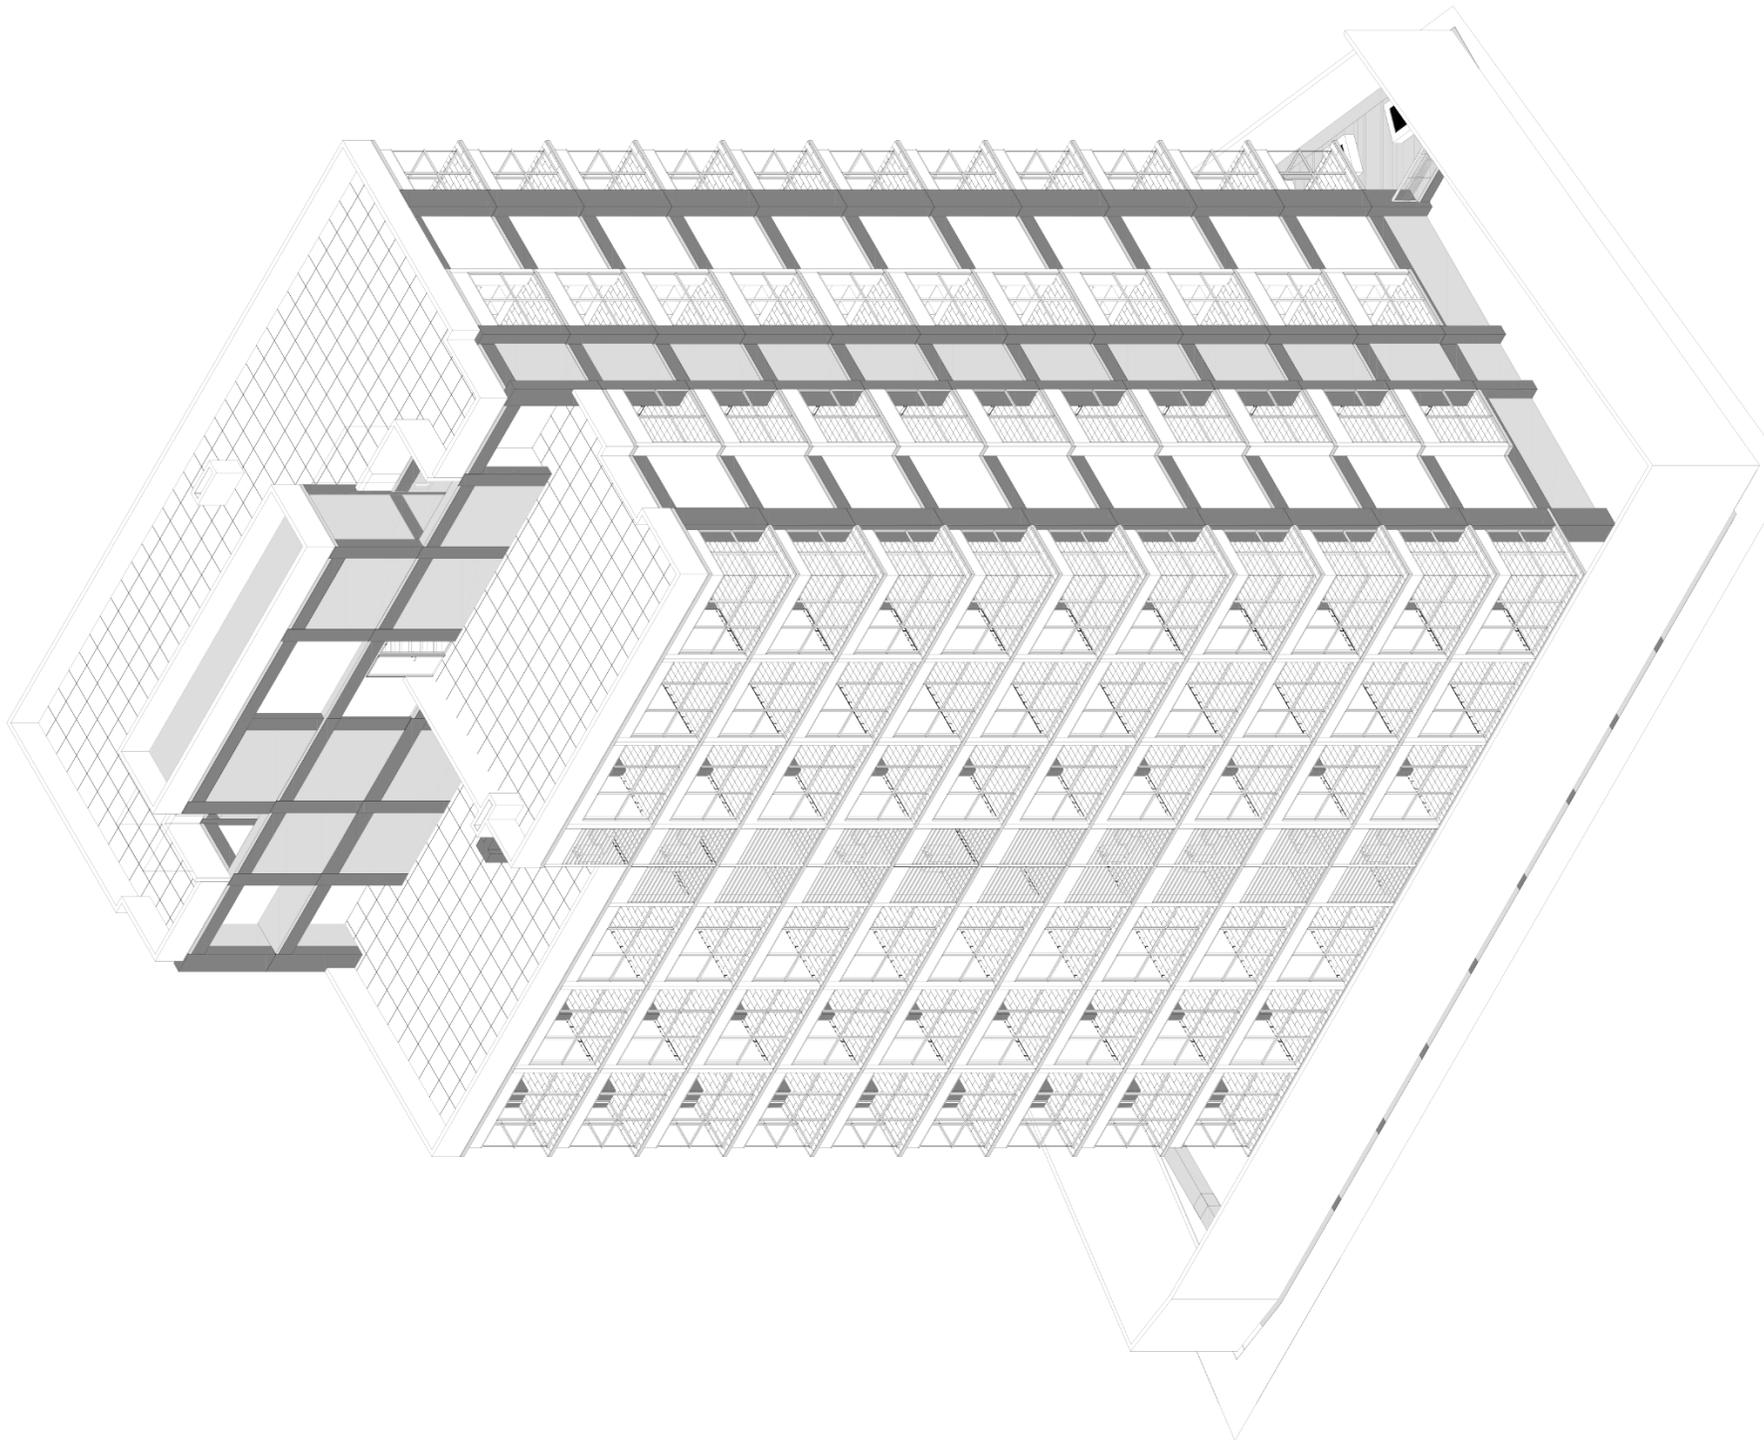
APUNTE PERSPECTIVO. Fachada posterior y fachada sur
